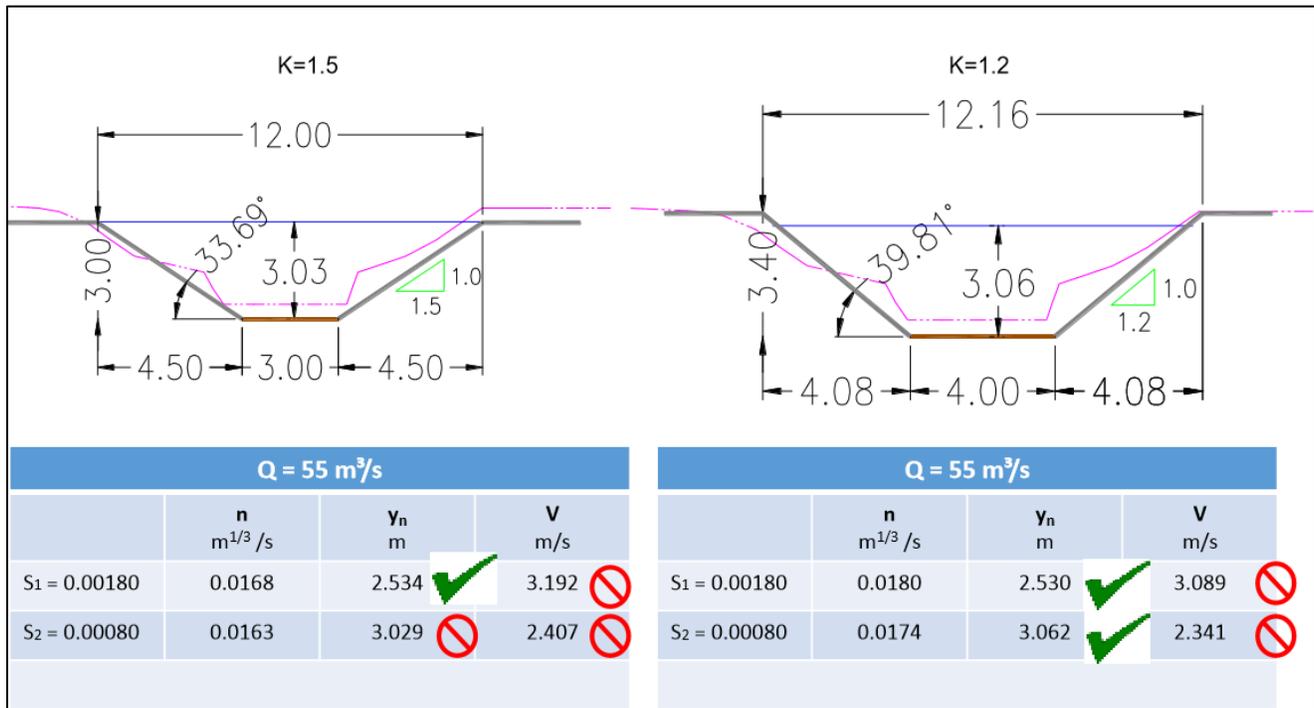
Opción 2 Sección de concreto con fondo móvil (terreno natural).
